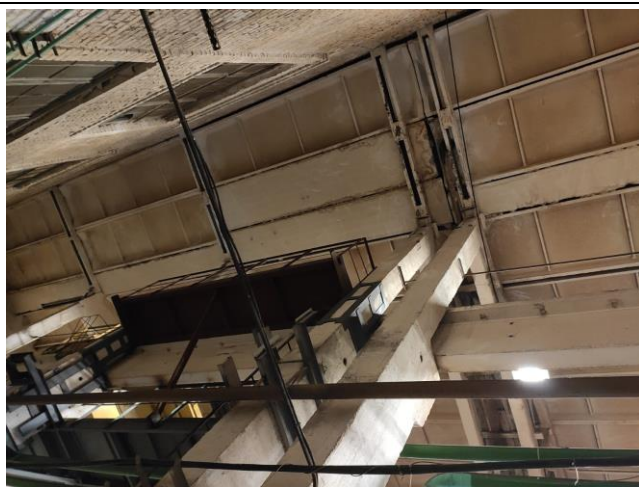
Следы замкания. Коррозия металлических балок покрытия. Разрушение защитного слоя бетона плит покрытия в осях Г-Д/12-14.
